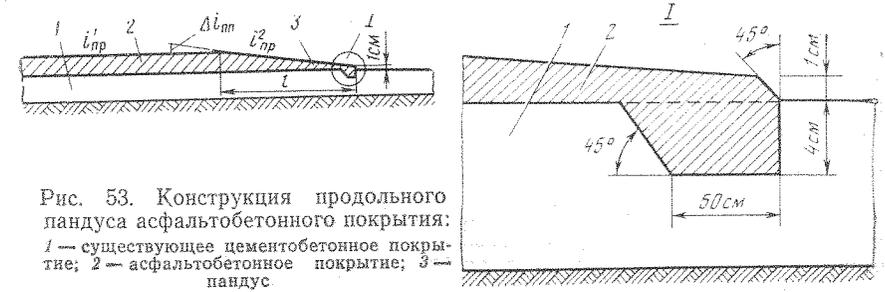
Конструкция продольного пандуса асфальтобетонного покрытия: 1 — существующее цементобетонное покрытие; 2 — асфальтобетонное покрытие; 3 — пандус
